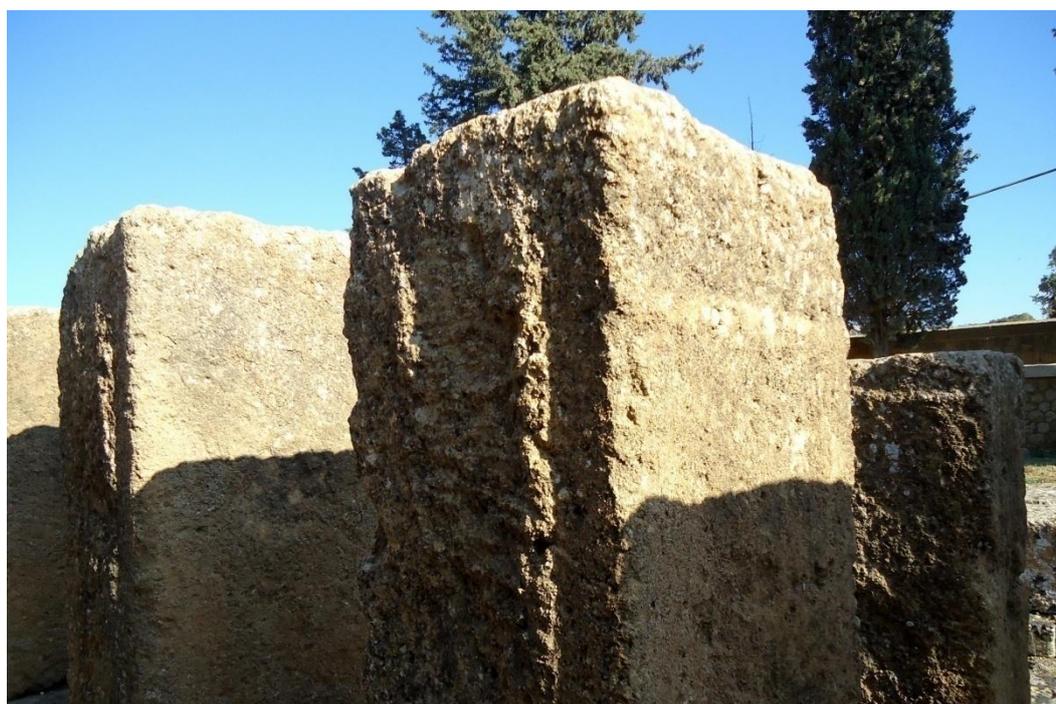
In alto: la periténeia presente sulla faccia a) dei piedritti di fondazione (2010).
